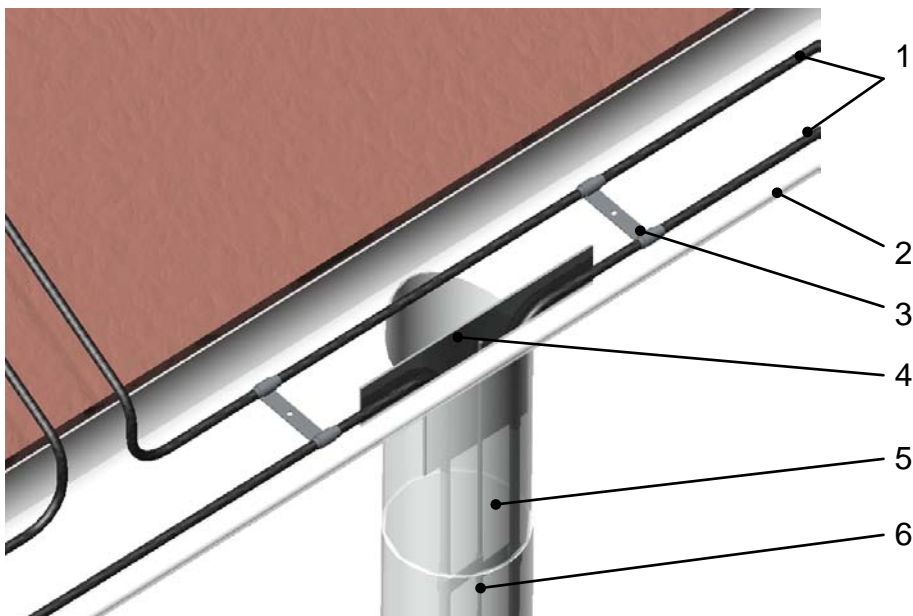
Крепление двух ниток нагревательного кабеля в водосточной трубе с переходом на лоток. Водосточная труба является промежуточной в системе лоток-труба. Поддерживающий трос крепится к элементу конструкции кровли. Т-образный кронштейн исключает излом кабеля в месте его перехода из лотка в водосточную трубу и обратно.
